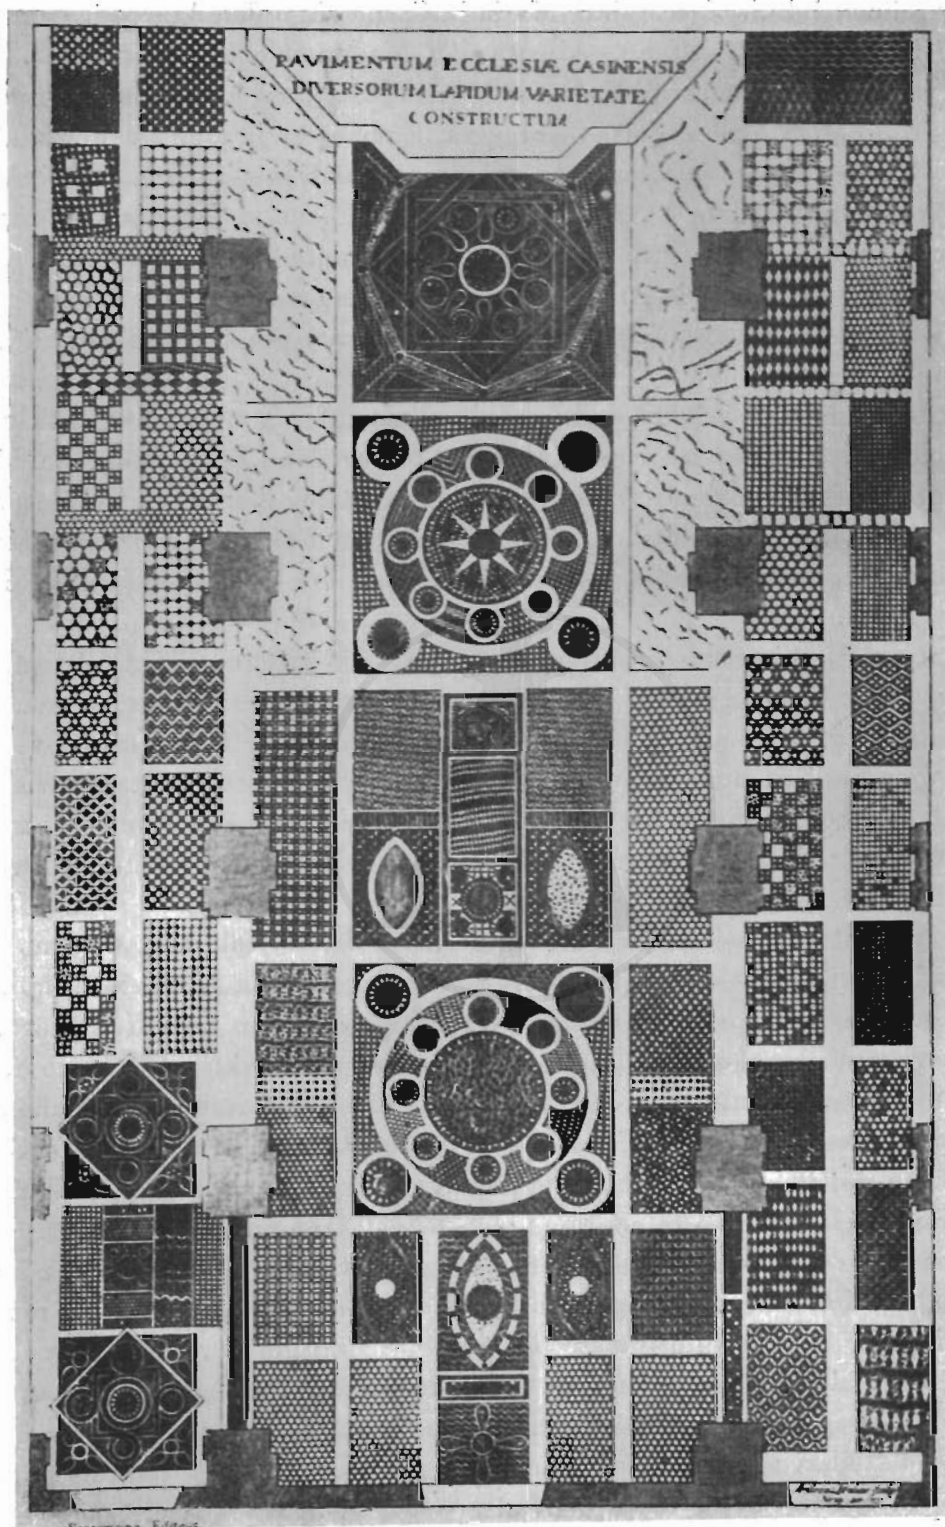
MONTECASSINO, ABBAZIA - Pavimento (dal Gattola).
